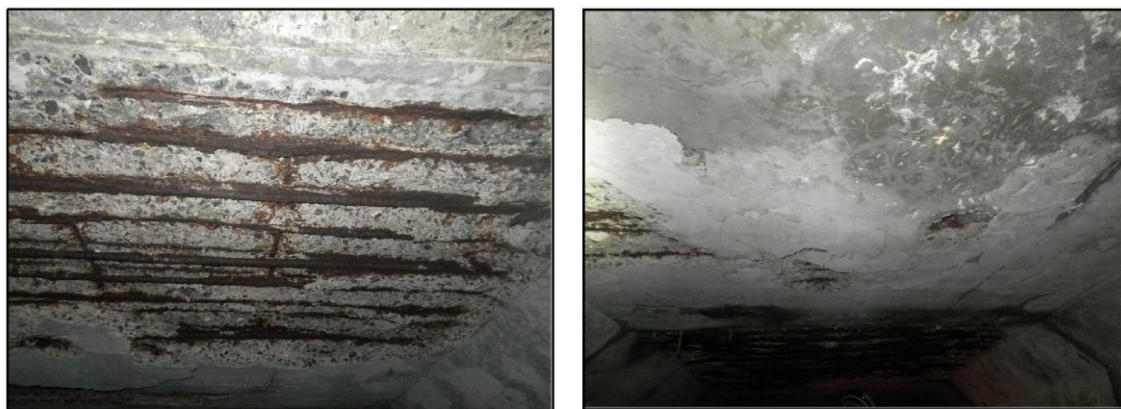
鉄筋腐食・コンクリートひび割れ
